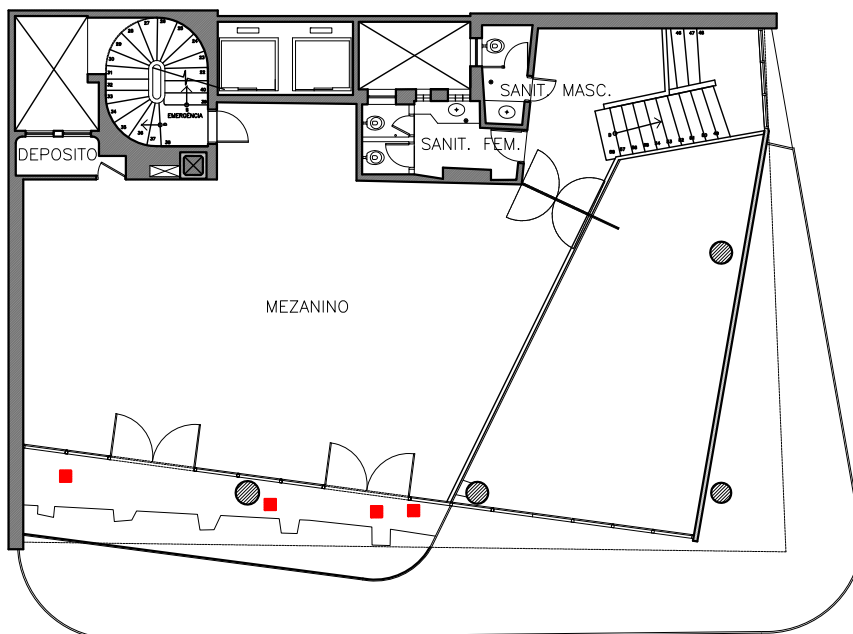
Planta do Quarto Pavimento - Identificação das armaduras expostas - Escala 1:200
